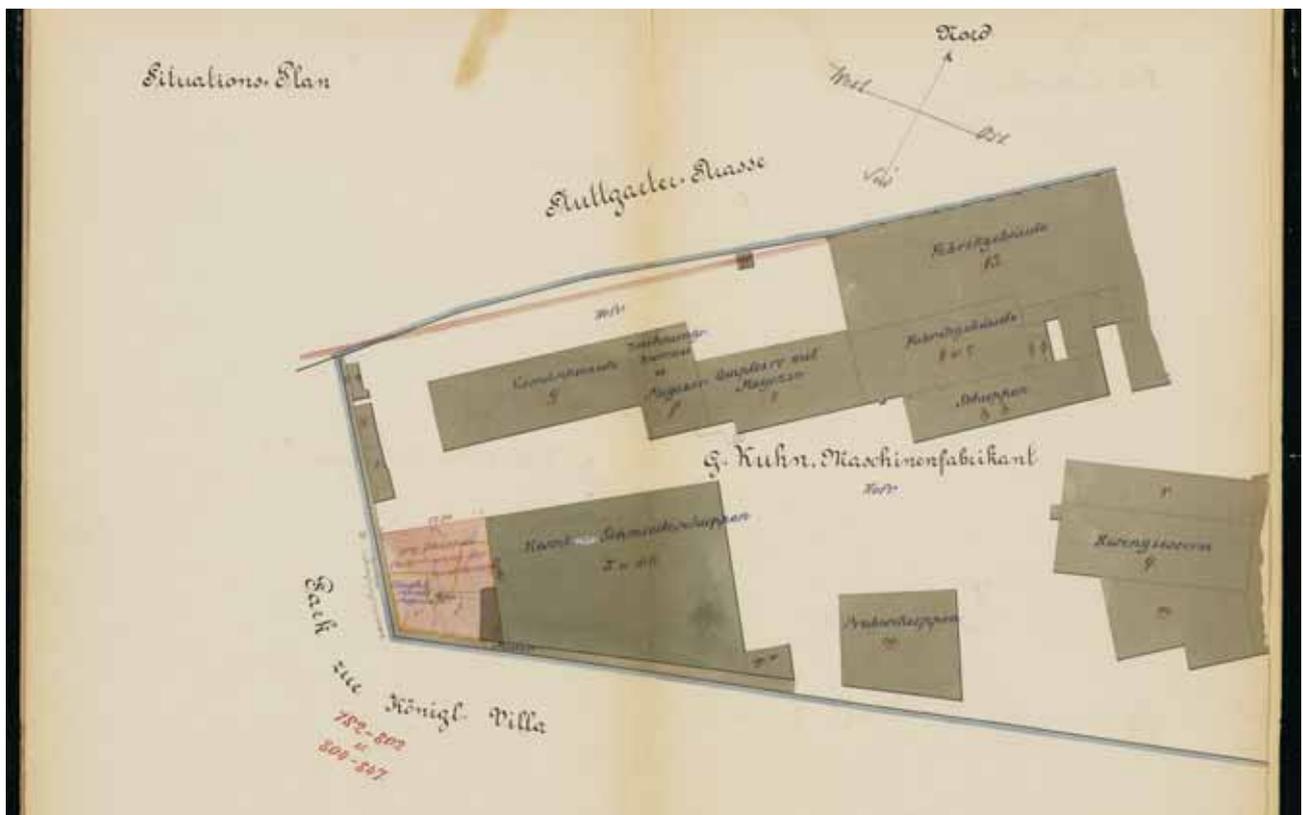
Lageplan im Bauantrag zur Erweiterung einer Kesselschmiede mit Gaswerk um 1880.
